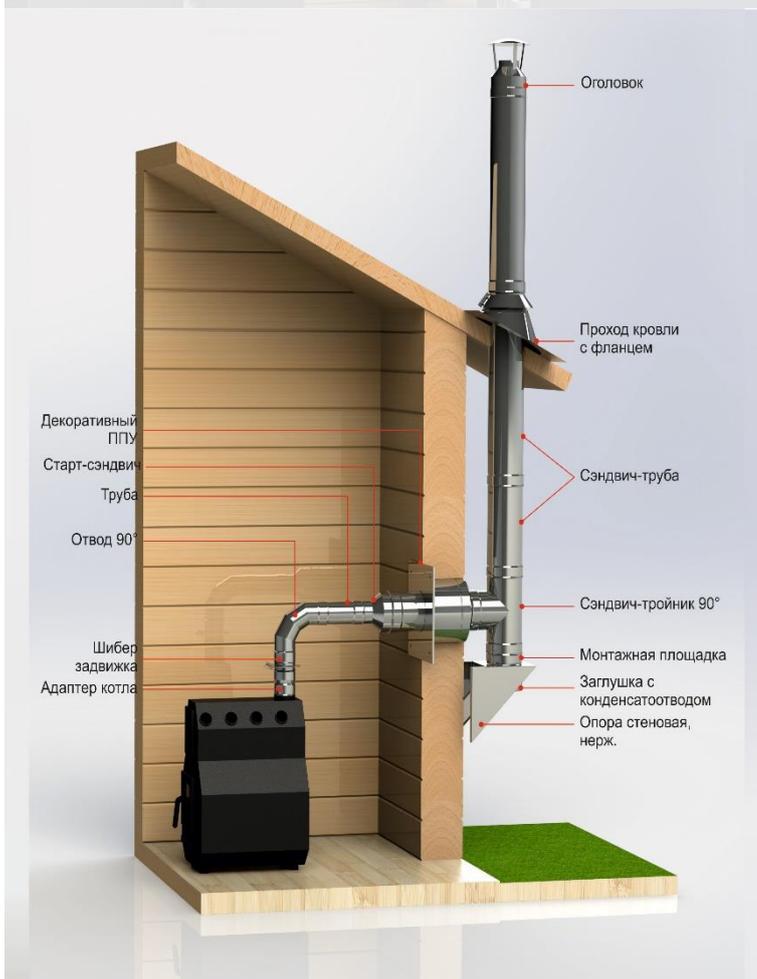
Двустенный вертикальный дымоход на внешней стороне стены с проходом через стену и кровлю при вертикальном выходном патрубке котла.
